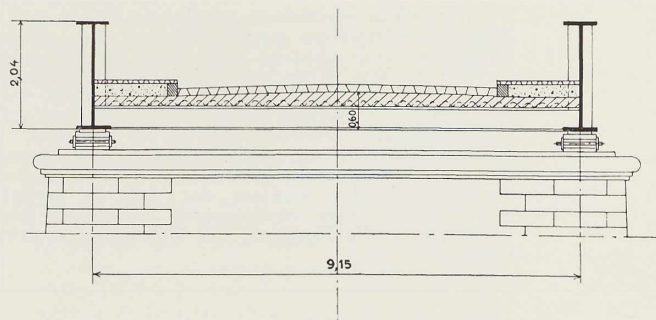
Emploi de la poutre Alpha pour les entretoises.
